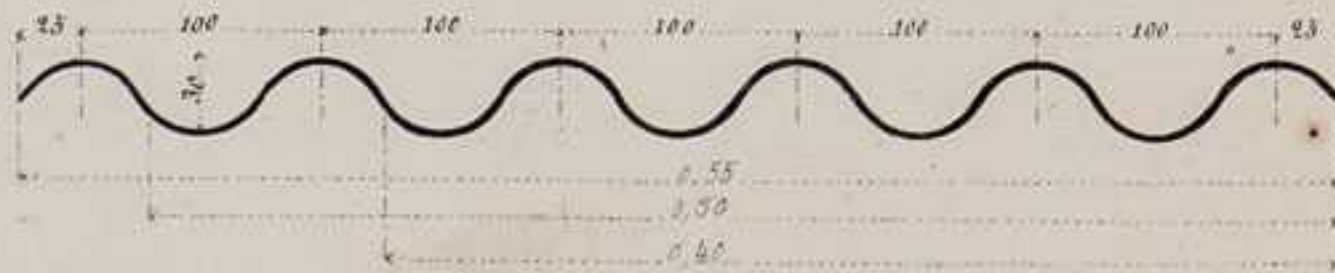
Sezione di lamiera ondulata, lunga 1 m. 65.
